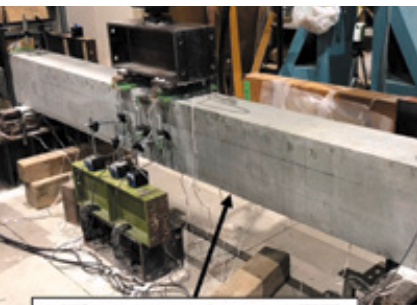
補強した鉄筋コンクリート桁の疲労荷重試験
